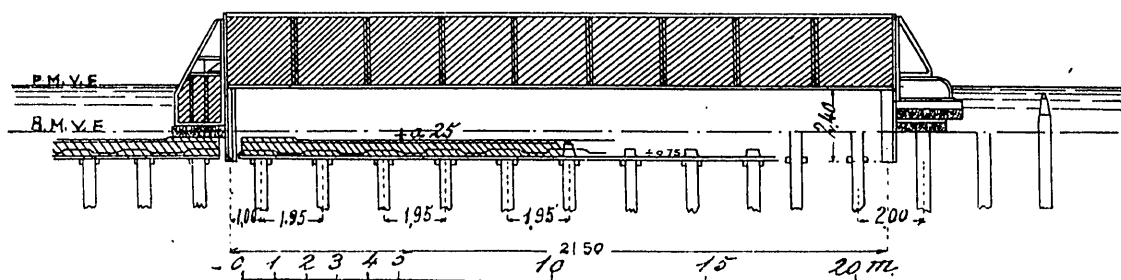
ª Campana de buzo para construir la plataforma inferior.
